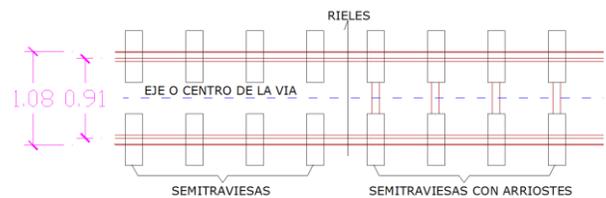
Detalle de semitraviesas y traviesas con arriostres. (Fuente: Autor)
